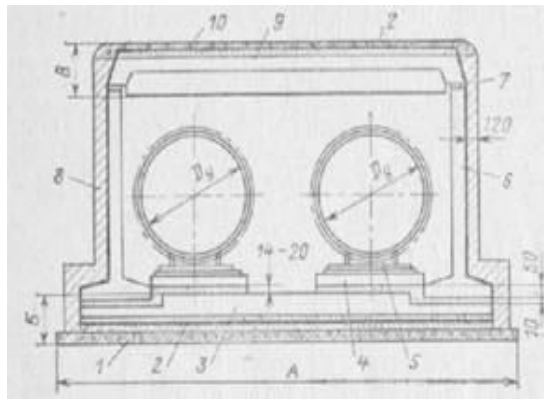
Непроходной железобетонный канал с гидроизоляцией для труб $D_u=800 - 1400$ мм:
